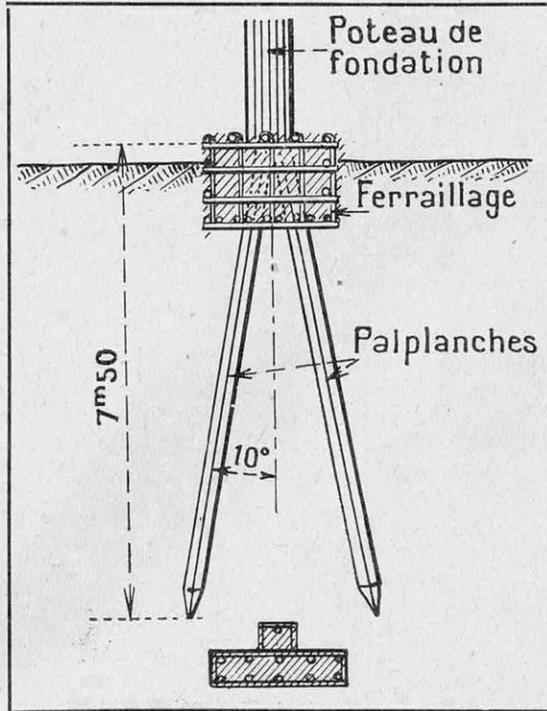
UN ÉLÉMENT DES FONDATIONS DU BUILDING-HOPITAL
